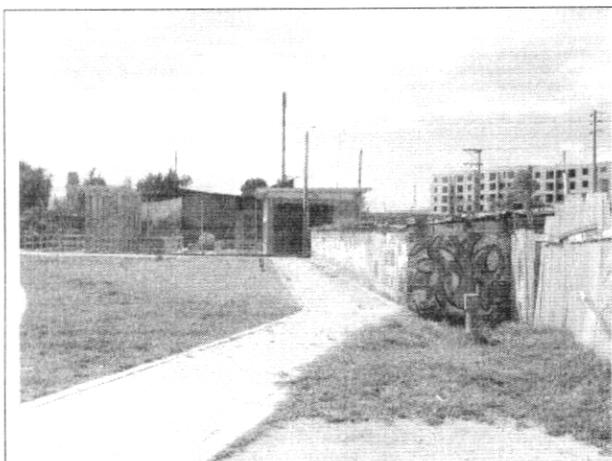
Detalle de la Planta de Bombeo Villa Gladys de la EAAB.
